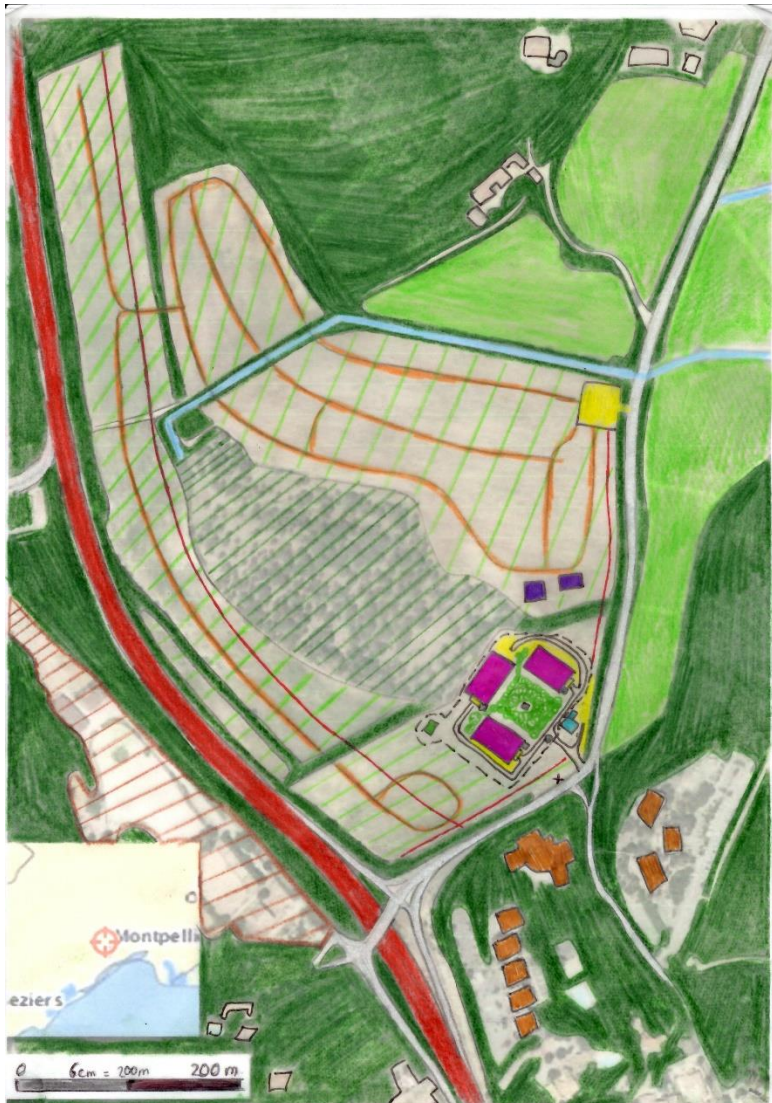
Plan des installations sur le terrain, source: Clara Sarnelli
